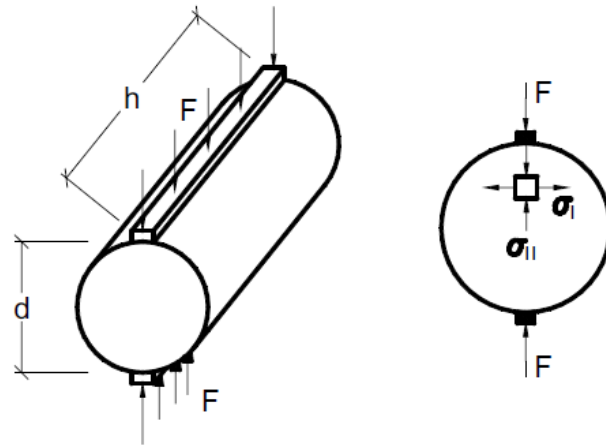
Resistência do concreto à tração por ensaio de compressão diametral
